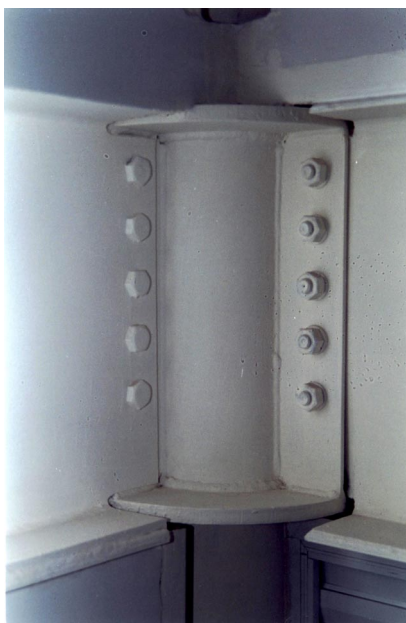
Detalhe de anel de ligação e vigas tipo “I” e pilares tubulares
